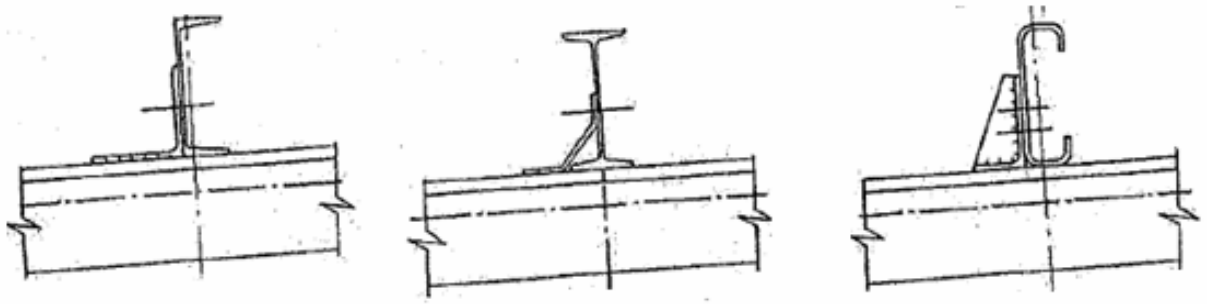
Вузли обпирання на ферму сталевих прогонів і варіанти їхнього кріплення
